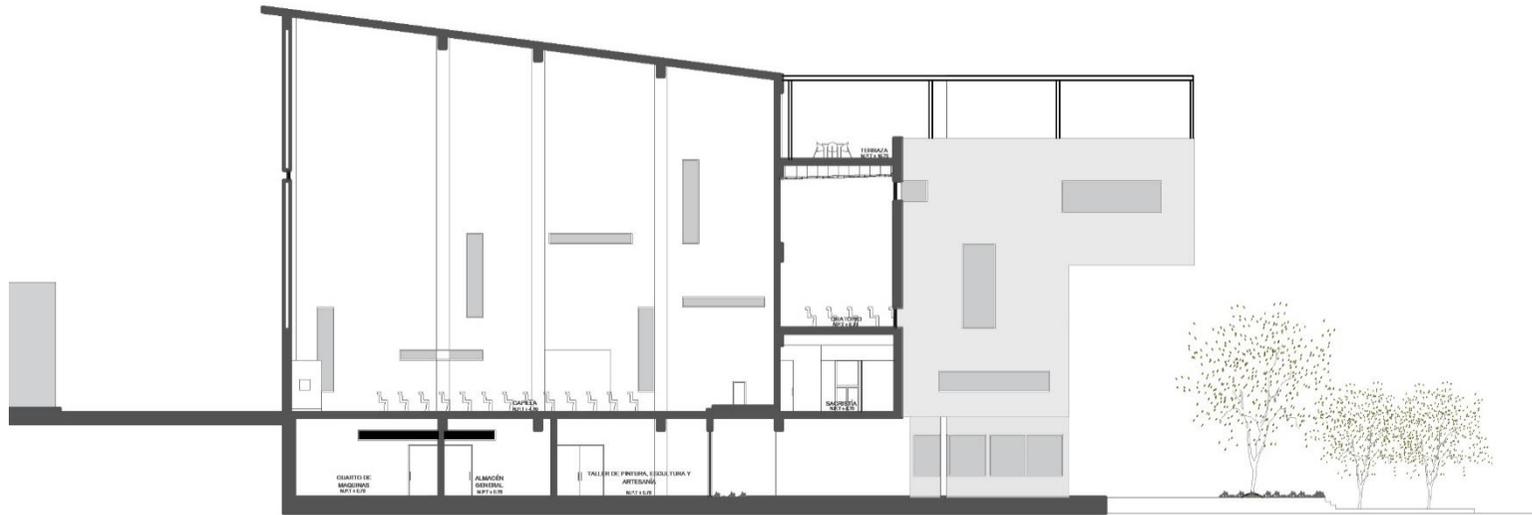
Corte longitudinal 3. Fuente: Propia.
